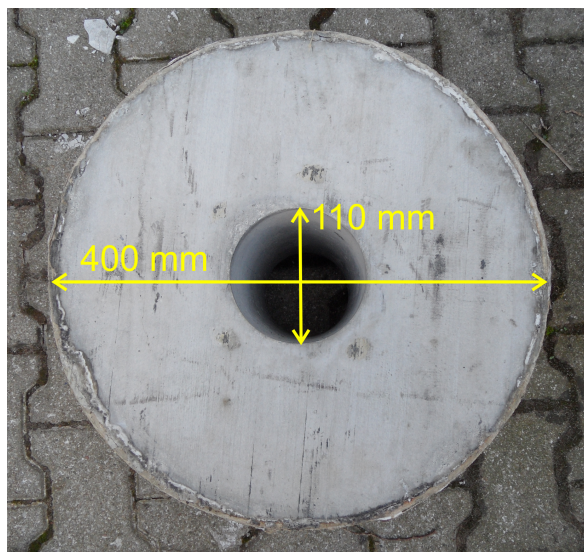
Nachgebildeter Tübbingausschnitt mit Einbauöffnung für die Stauchelemente
